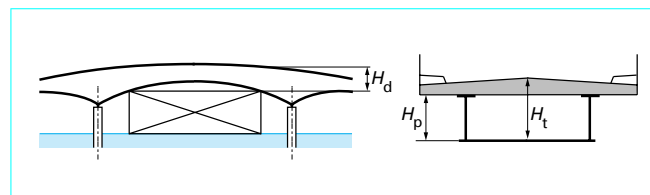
Hauteur disponible et hauteur nécessaire de construction
